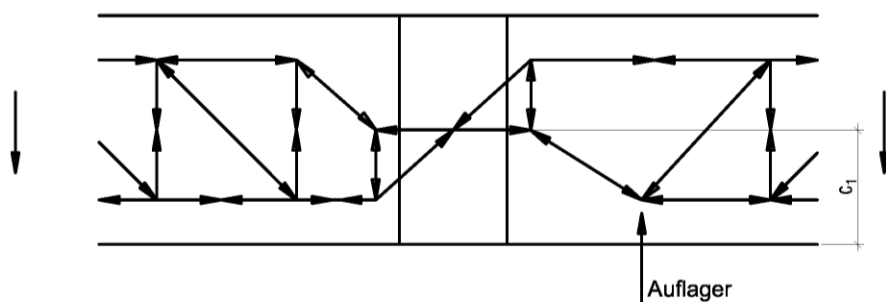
Schöck Isokorb® Typ Q mit Betondrucklager
